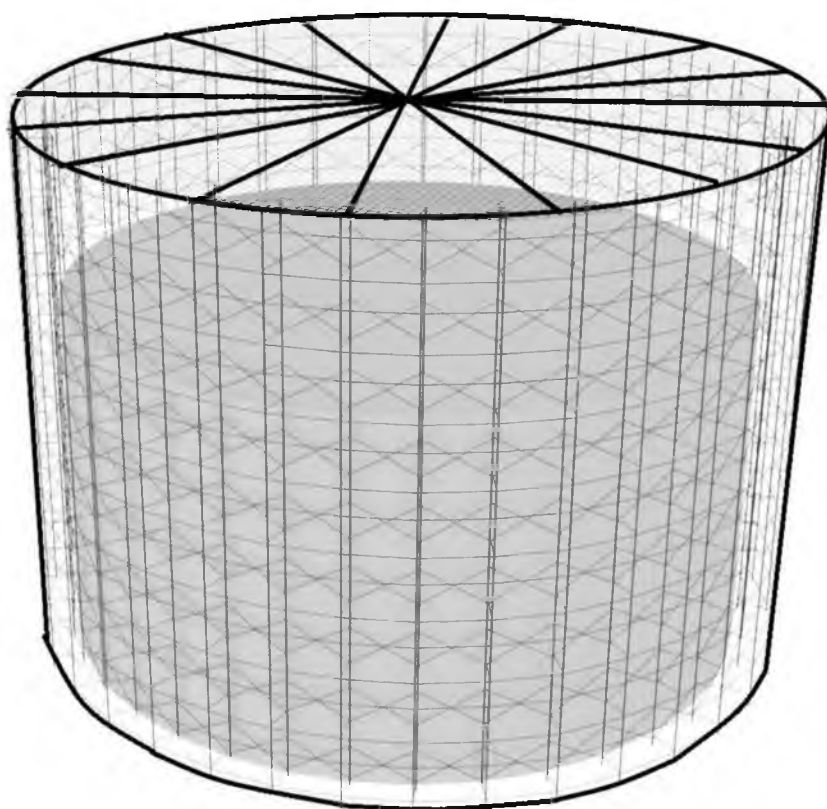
Схема укрытия вертикального резервуара с использованием строительных лесов и сетки рабица
